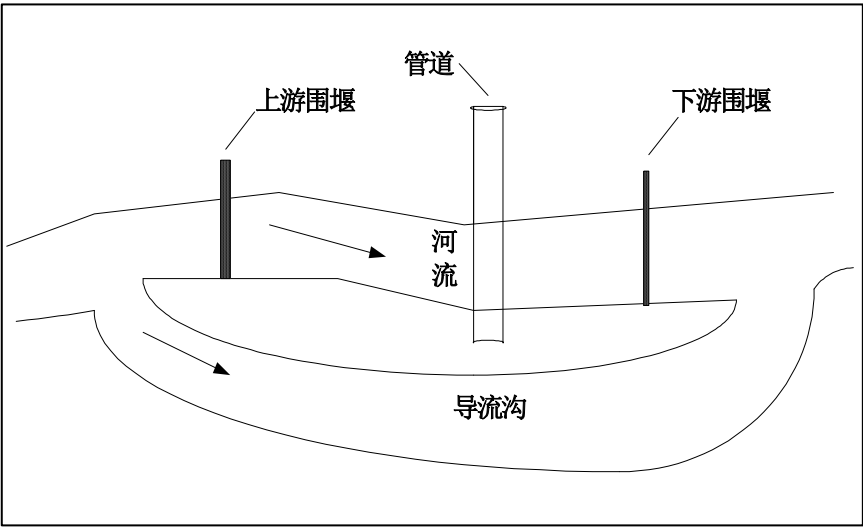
围堰导流开挖管沟法施工断面示意图
